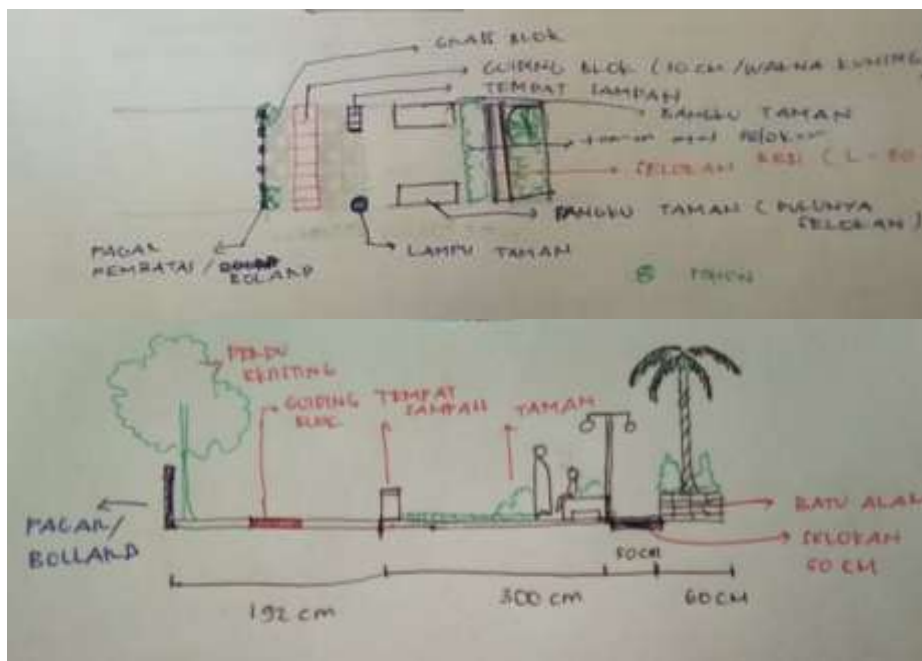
Rencana *Site Plan* Segmen 1 pada Area 1(halte)
